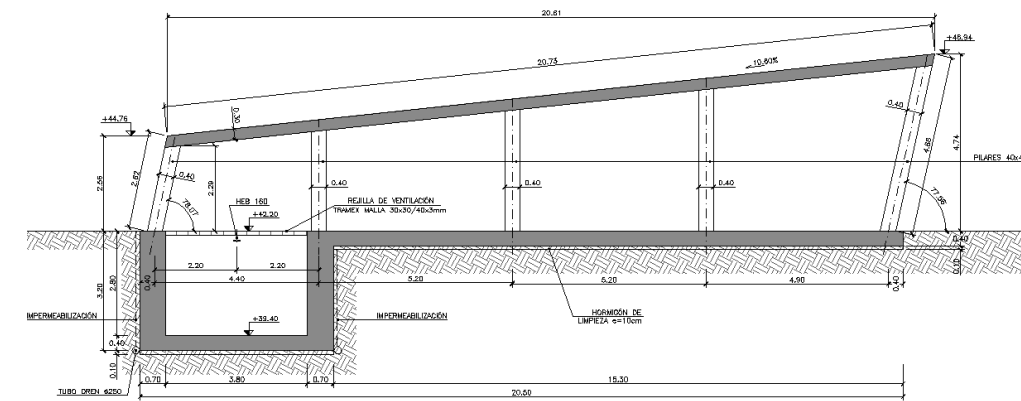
Sección longitudinal edículo instalaciones (fuente: PC estación El Carrizal)
